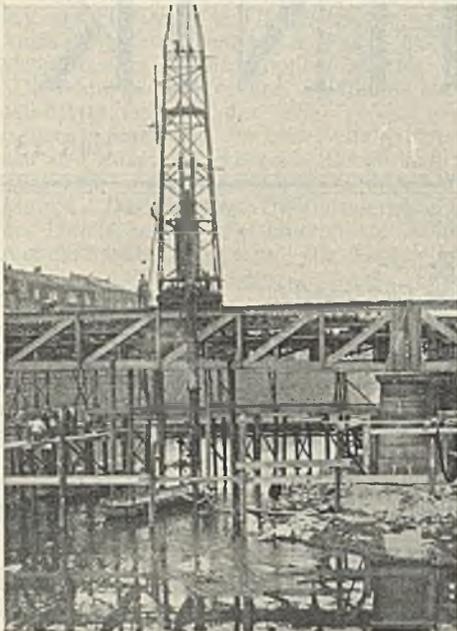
Rammung des Lehrgerüsts unter Benutzung der alten Brücke als Rammgerüst.
